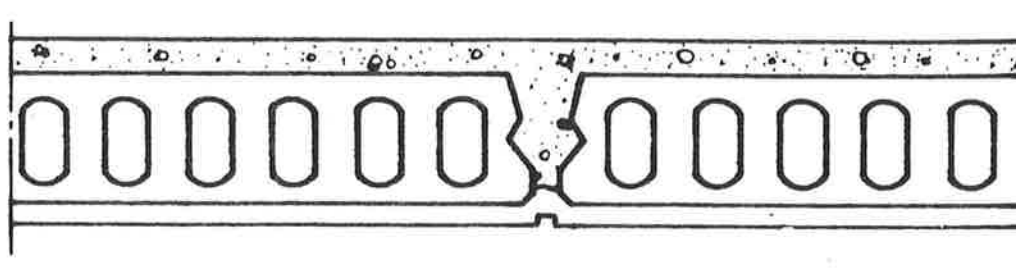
Seção transversal de uma laje constituída com painéis pré-moldados de concreto protendido.
